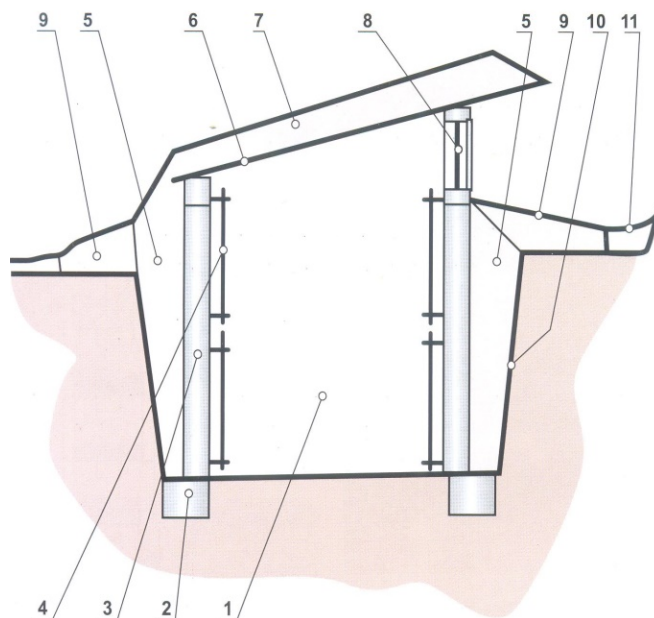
Схема траншейной теплицы (слева): рабочее помещение; 2 – ленточный фундамент; 3 – металлические стойки; 4 – стеновое покрытие; 5 – засыпка из теплоизоляционного материала; 6 – потолочное перекрытие; 7 – теплоизоляция кровли с гидроизоляцией; 8 – окно из многослойного стеклопакета; 9 – откосы стен; 10 – гидроизоляция откосов; 11 – водоотводящий желоб
